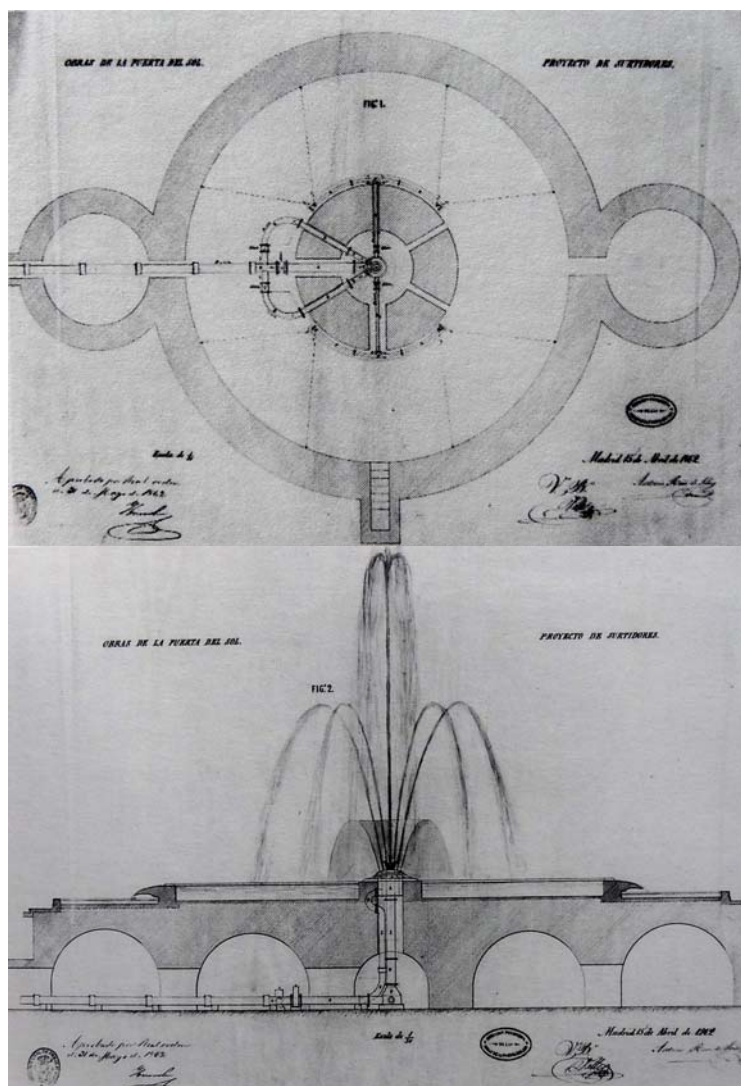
Planta y Alzado del "Proyecto de surtidores" para las "Obras de la Puerta del Sol" firmado por el arquitecto Antonio Ruiz de Salces el 15 de abril de 1862, que preveía simetrizar la fuente duplicando el rebosadero en forma de venera.
